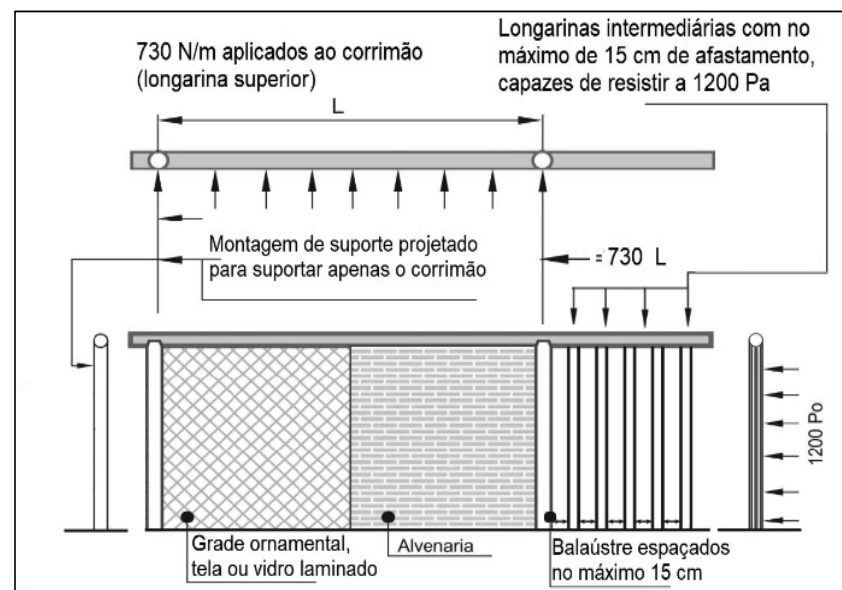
Pormenores construtivos da instalação de guardas e as cargas a que elas devem resistir.
